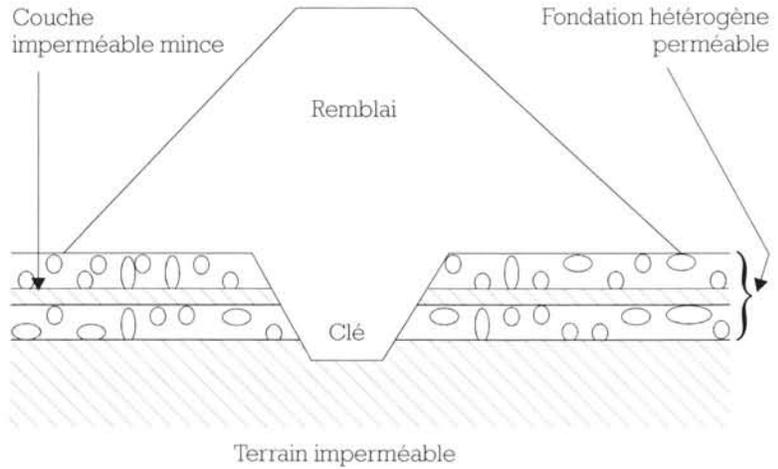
Clé d'étanchéité d'un barrage homogène (ancrage correct dans le terrain imperméable épais).
